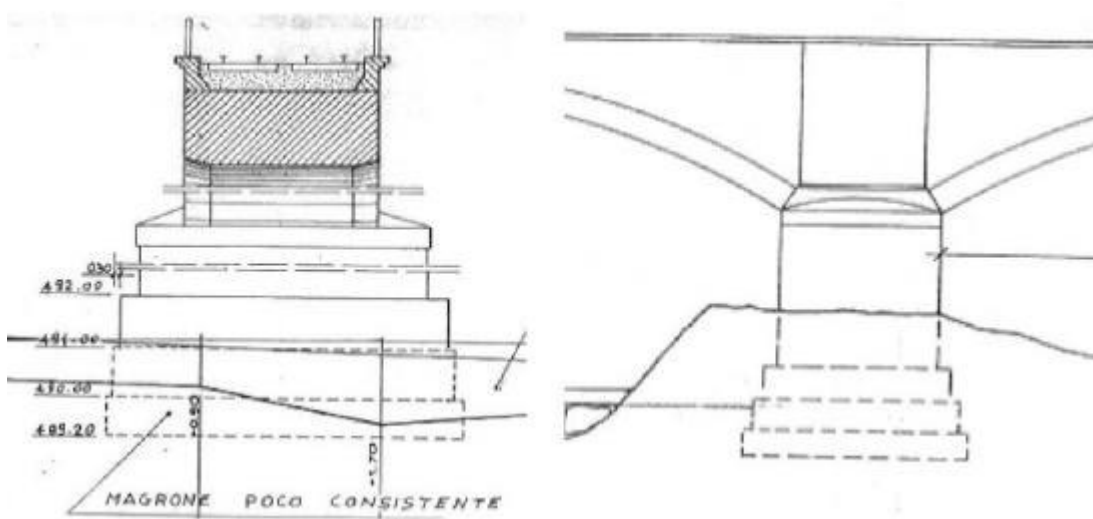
Fondazione diretta - ponte Gesso - linea Cuneo-Mondovì, progr. 0+229 (Archivio FS)
